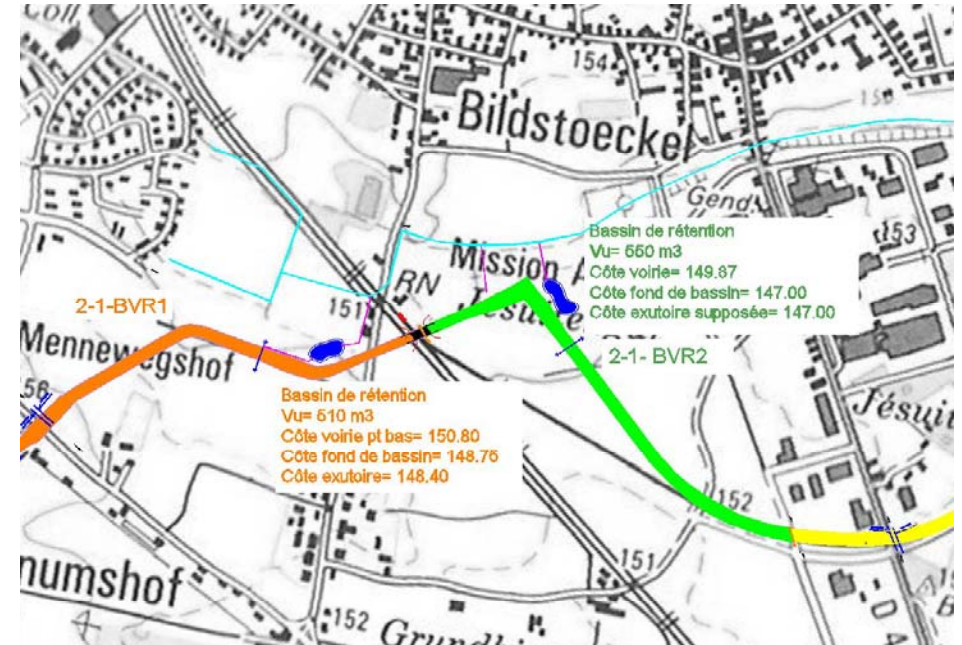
Localisation des ouvrages d'assainissement du tronçon 2-1
